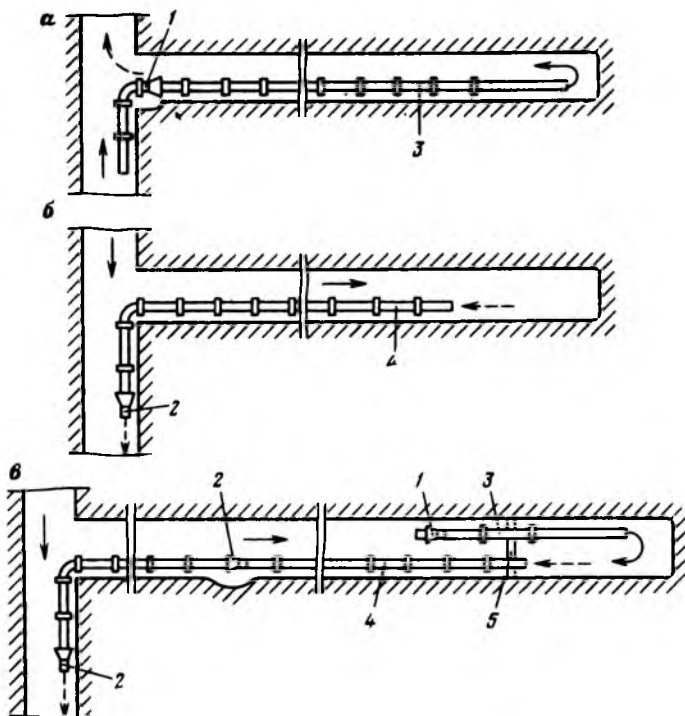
Схемы проветривания тупиковых частей подготовительных выработок: а — нагнетательный способ; б — всасывающий способ; в — комбинированный способ; 1 — нагнетательный вентилятор; 2 — всасывающие вентиляторы; 3 — нагнетательный трубопровод; 4 — всасывающий трубопровод; 5 — перемычка
